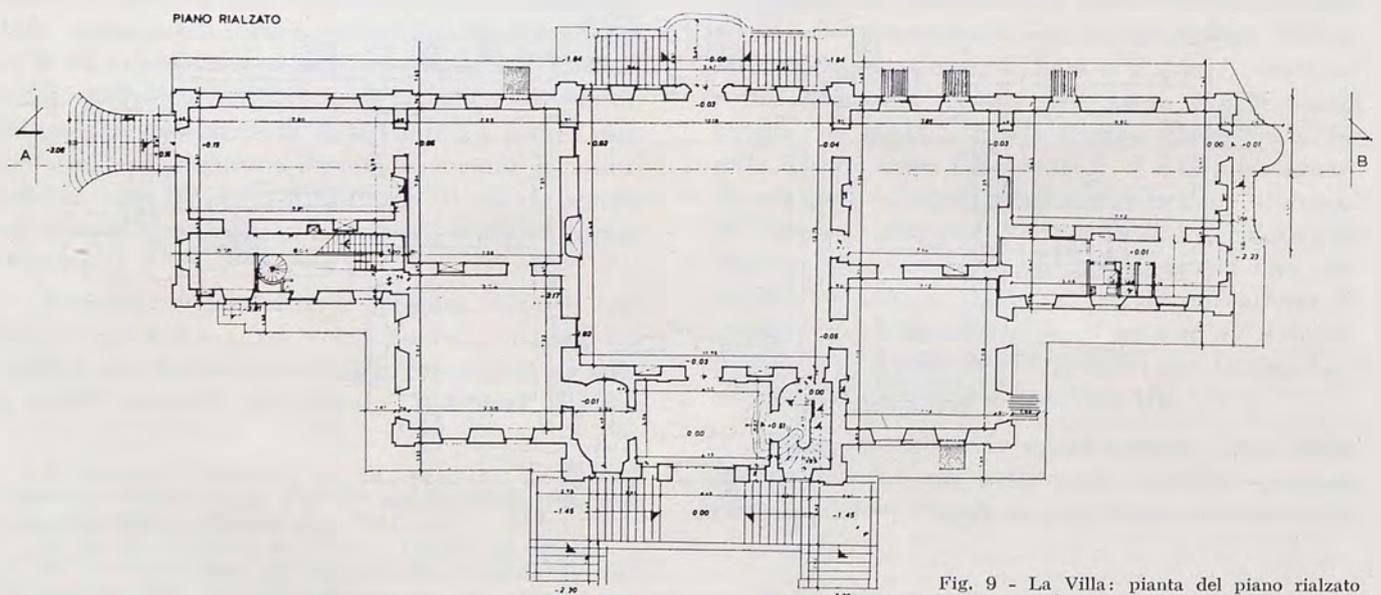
La Villa: pianta del piano rialzato nel progetto di intervento.
